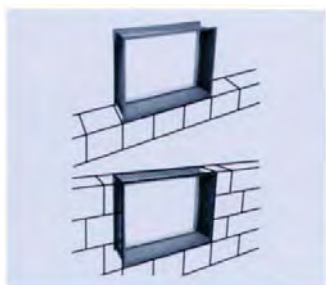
COLOCACIÓN DE MARCO EN MURO DE MAMPOSTERÍA
